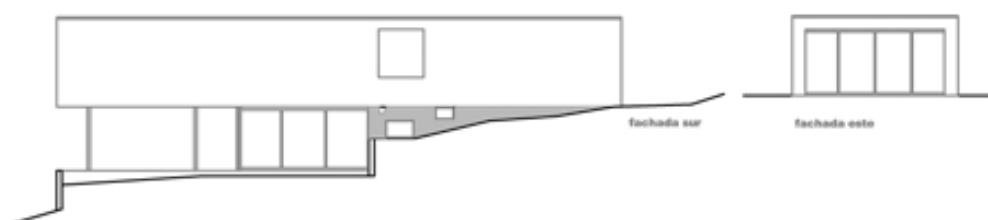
M. Jorreto: Casa 'flexible'. Alzados.
